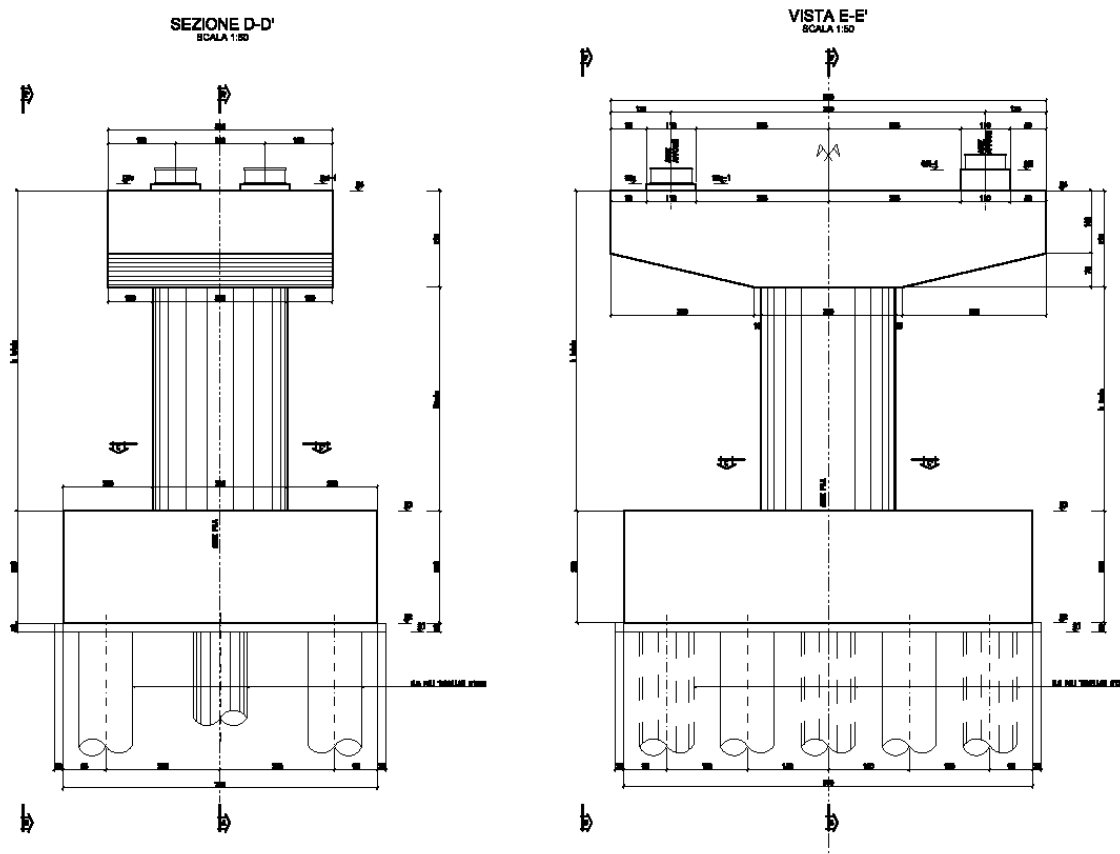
Prospetti (frontale e laterale) della pila tipo.
